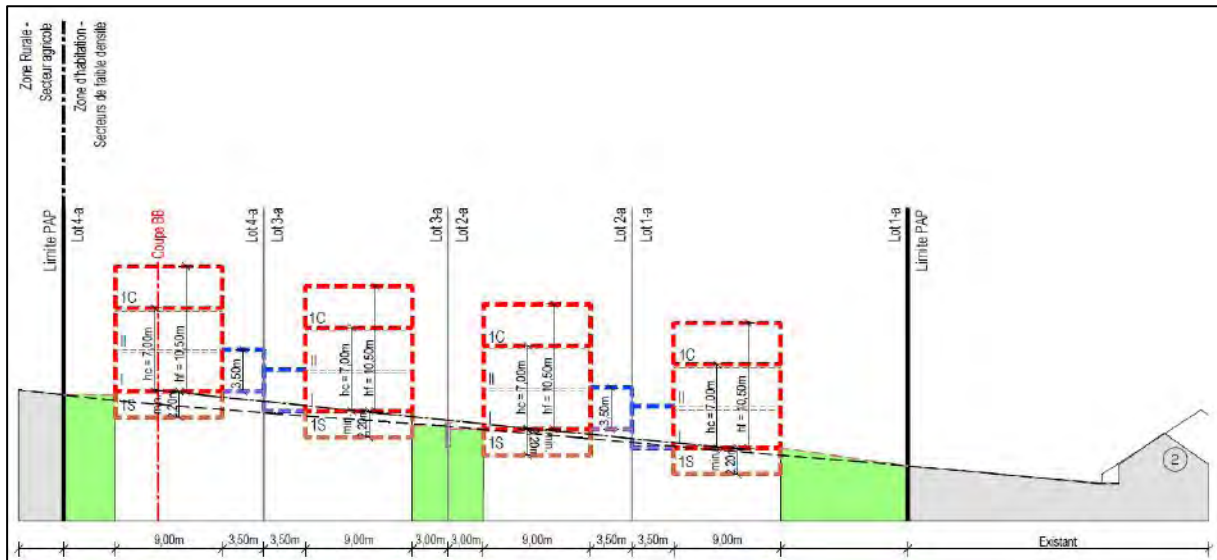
coupe B-B' du projet de modification ponctuelle du PAP (hors échelle)
